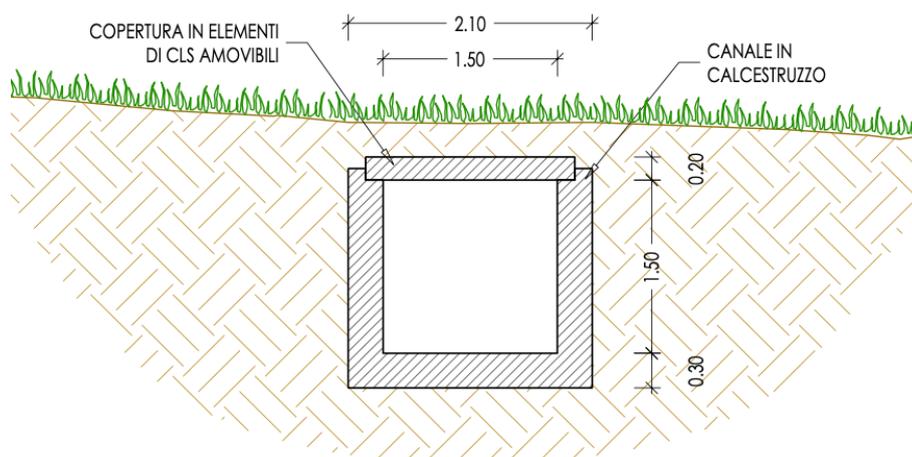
Sezione tipo canale in calcestruzzo armato
